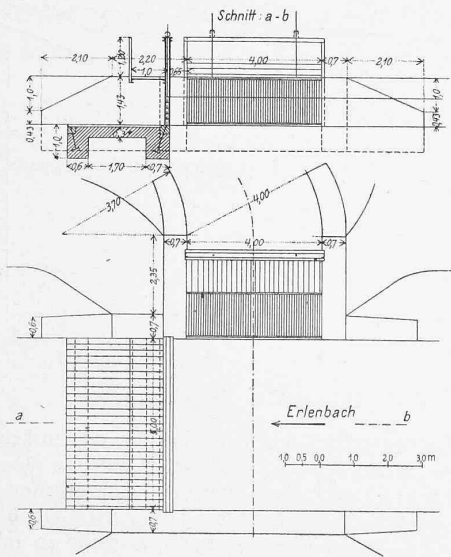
Wasserfassung im Erlenbach. Grundriss und Schnitt a-b. — Masstab 1:200.
